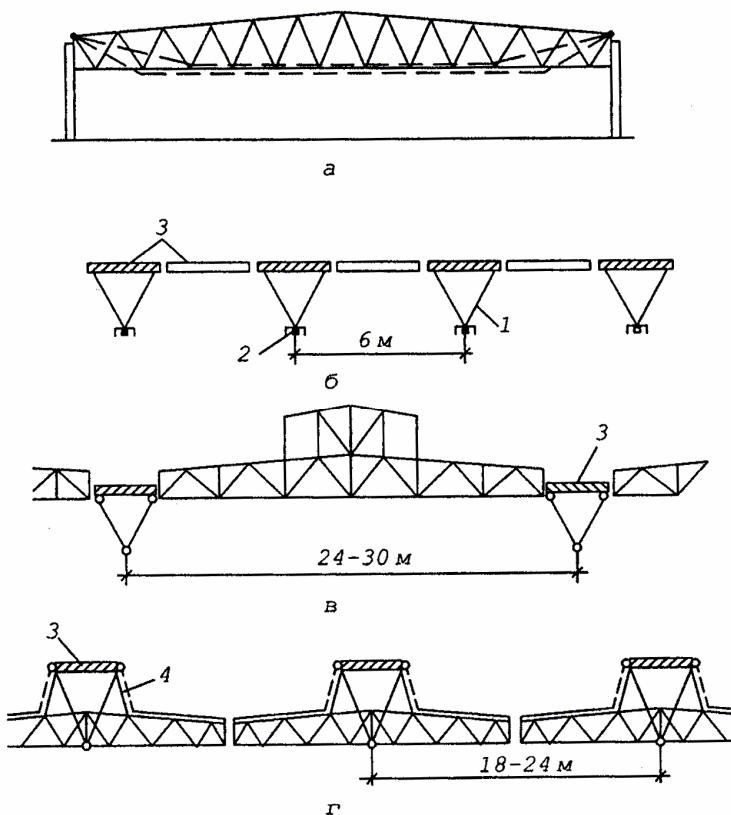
Покриття з тригранними балковими фермами: а – поперечний переріз; б, в, г – поздовжній переріз; 1 – тригранна ферма; 2 – затяжки; 3 – залізобетонні плити покрівлі; 4 – вікна ліхтарів
